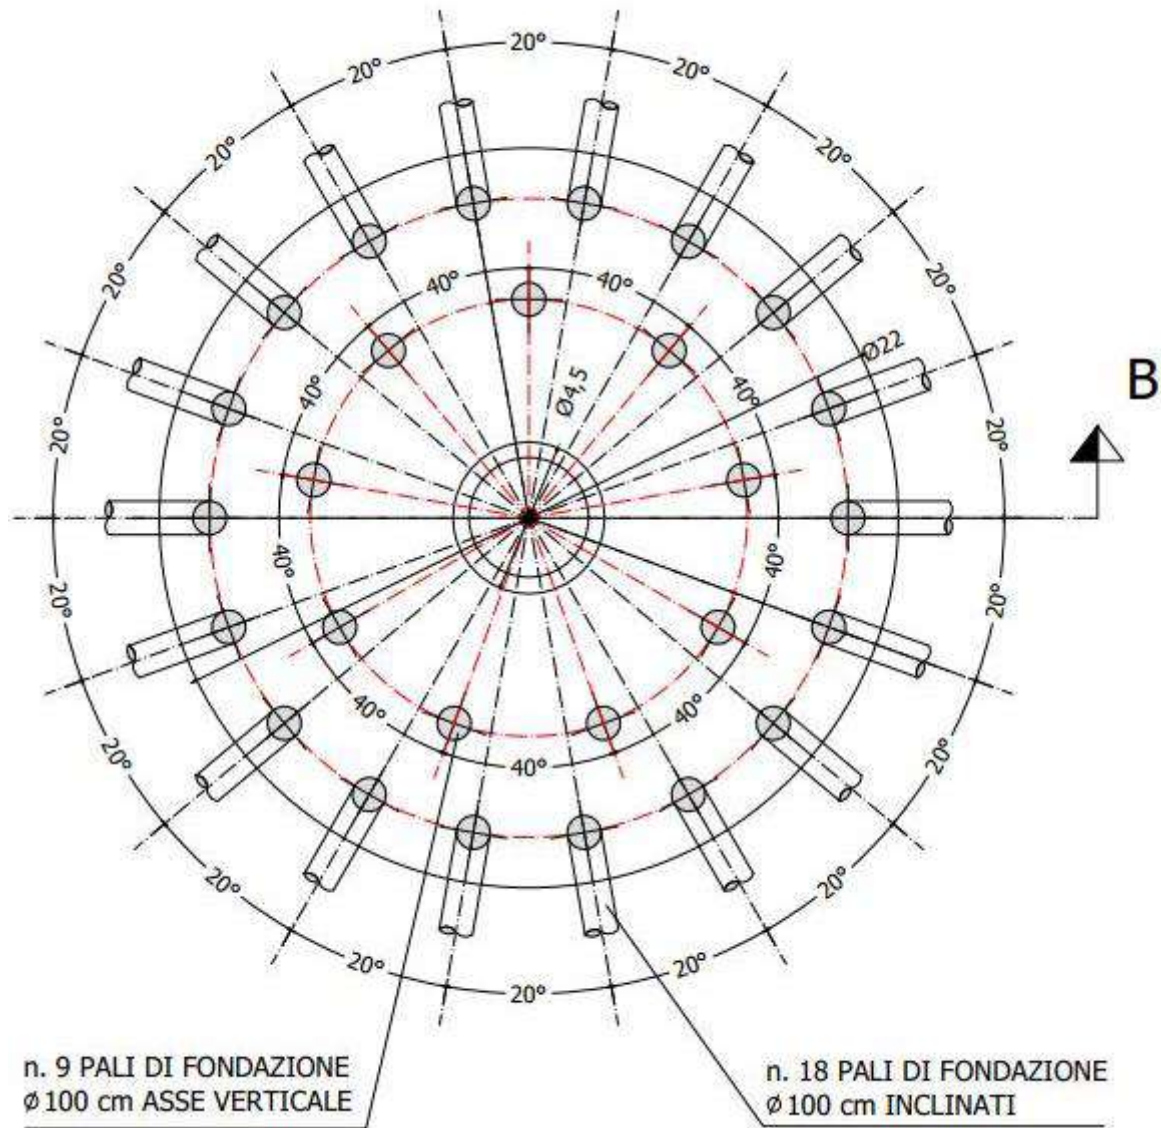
Schema strutturale delle fondazioni profonde – pianta piastra circolare e pali
